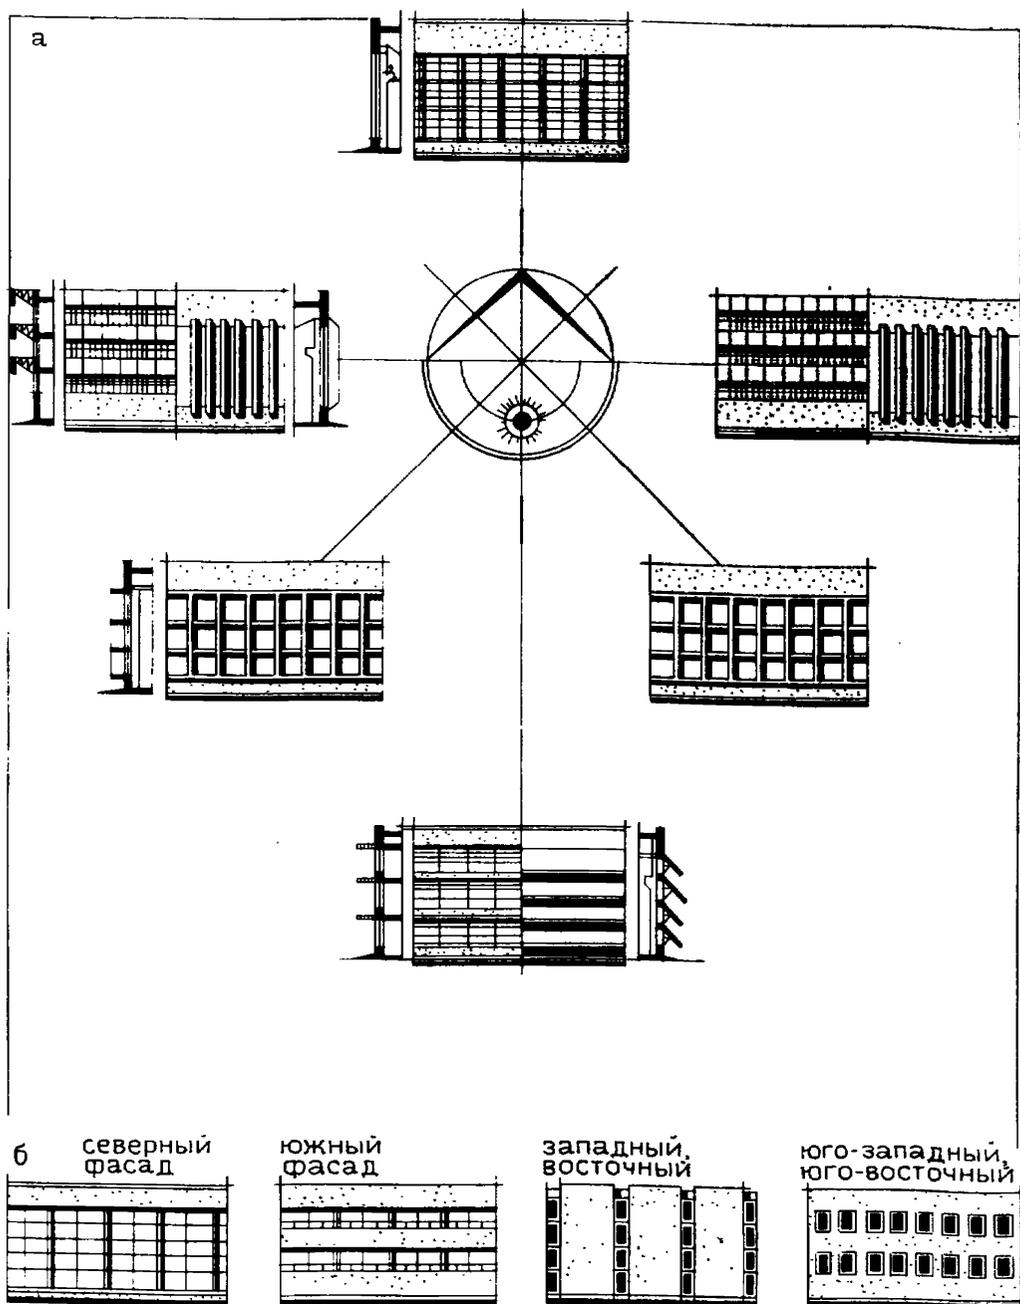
Приемы оптимального решения фасадов зданий с учетом инсоляции
